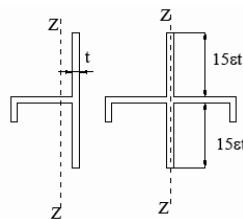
Irrigidimenti longitudinali dei pannelli d'anima
